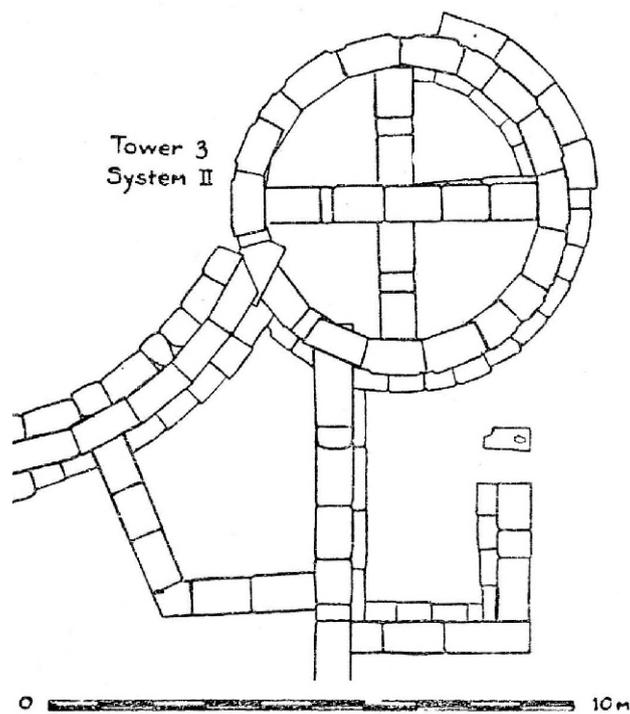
Grundriss des Rundturms von Halai, im gleichen Maßstab
